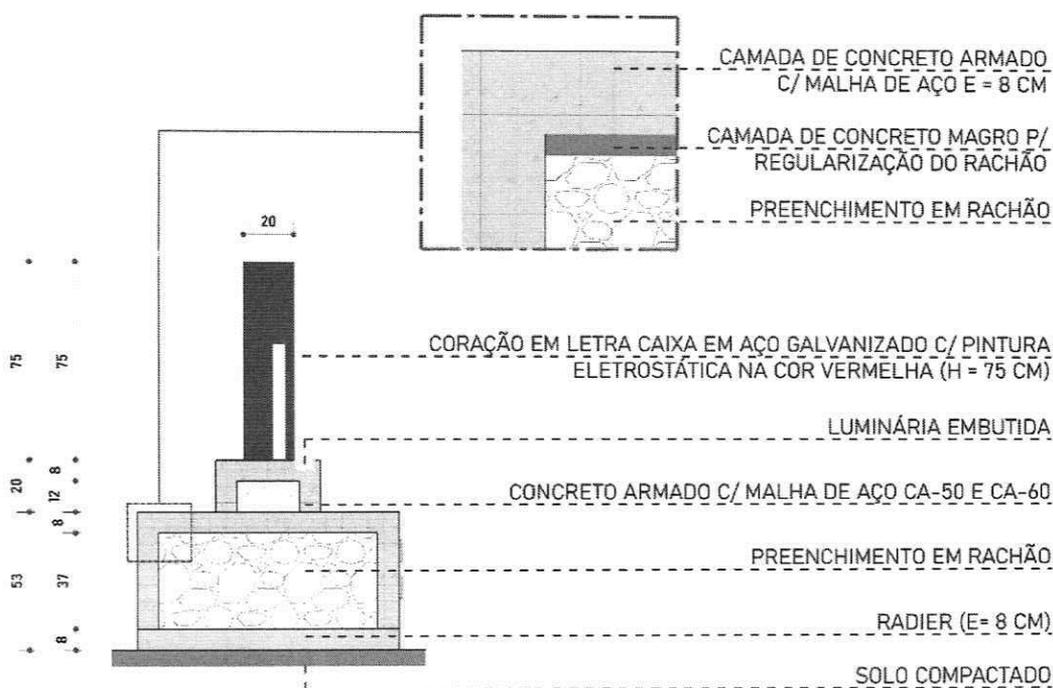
Detalhe construtivo da base para fixação dos letreiros (corte)
